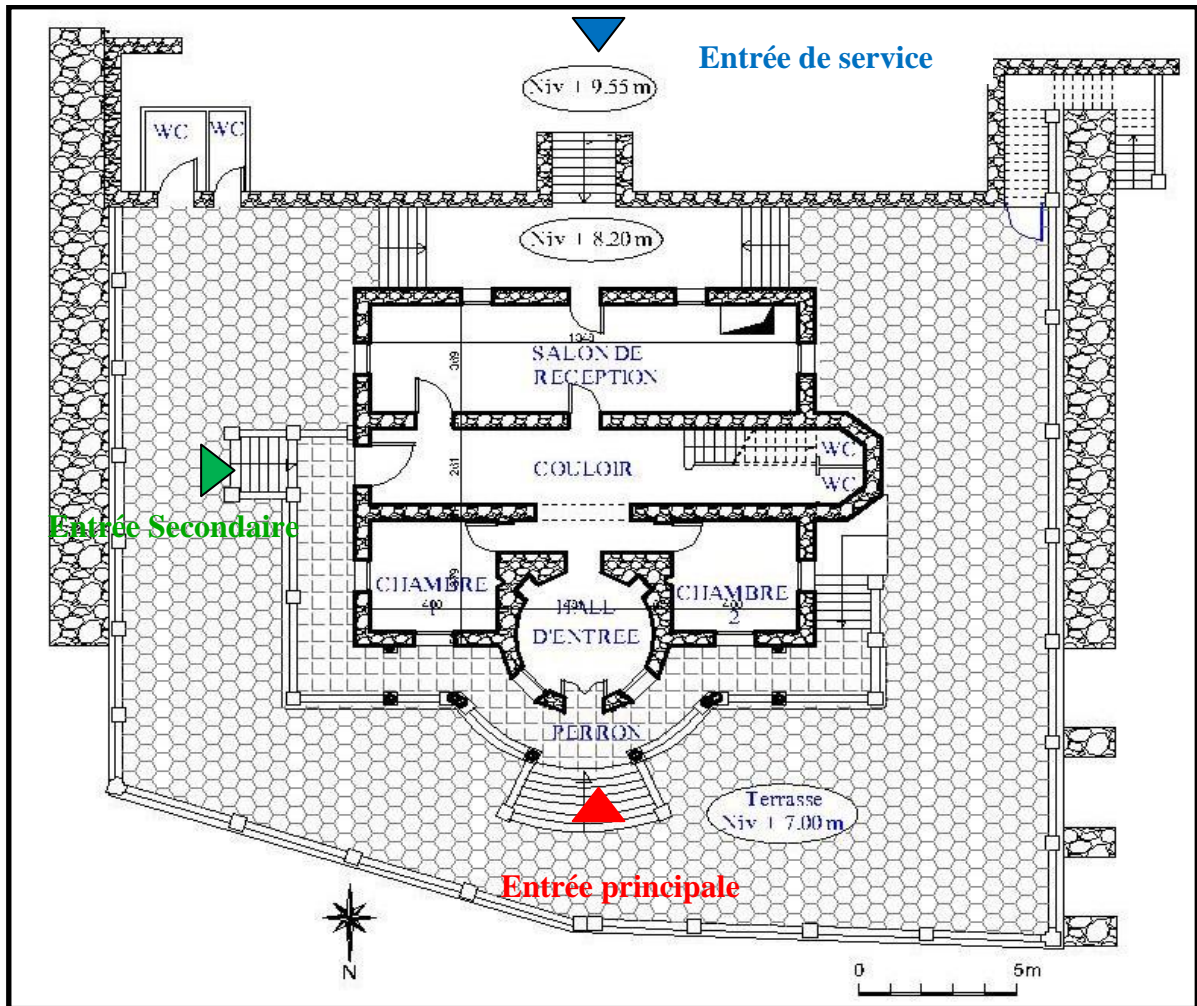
25: Plan rez-de-chaussée du bâtiment principal.
